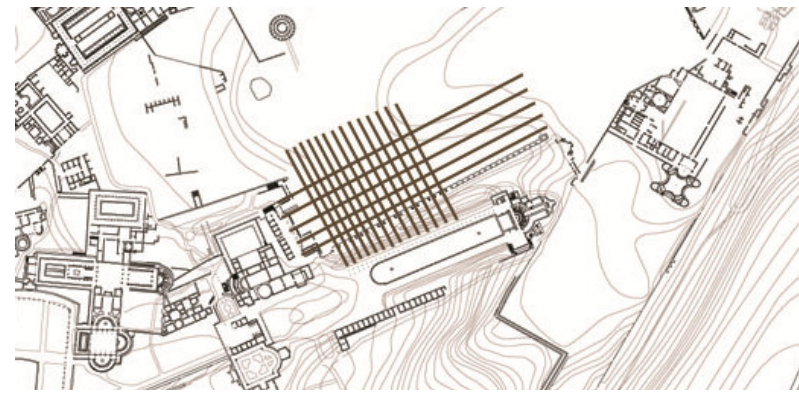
Planimetria con indicazione schematica degli assi ordinatori del progetto
